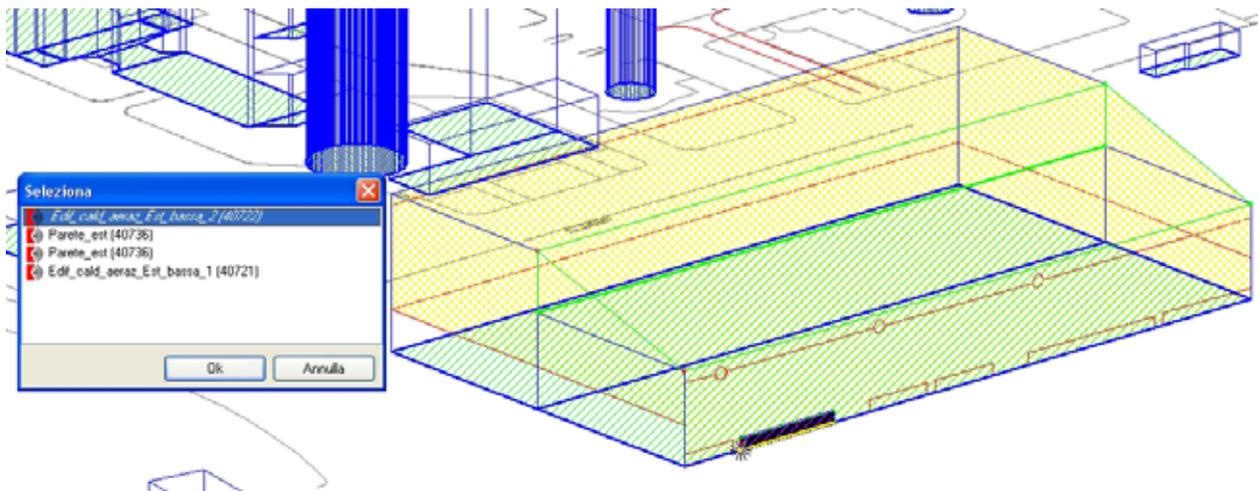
Nuovo edificio generatori di calore, porzione 2 ventilazione parete Est.
